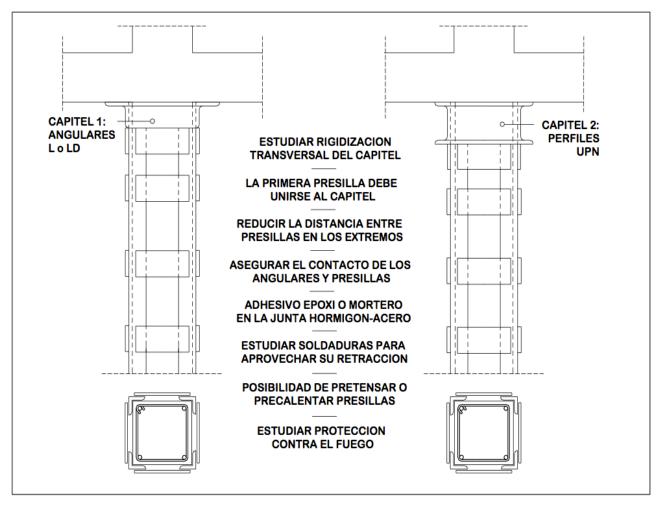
ilustración de capiteles. (Fuente: Patología, reparación y refuerzo de estructuras de hormigón armado de edificación)
